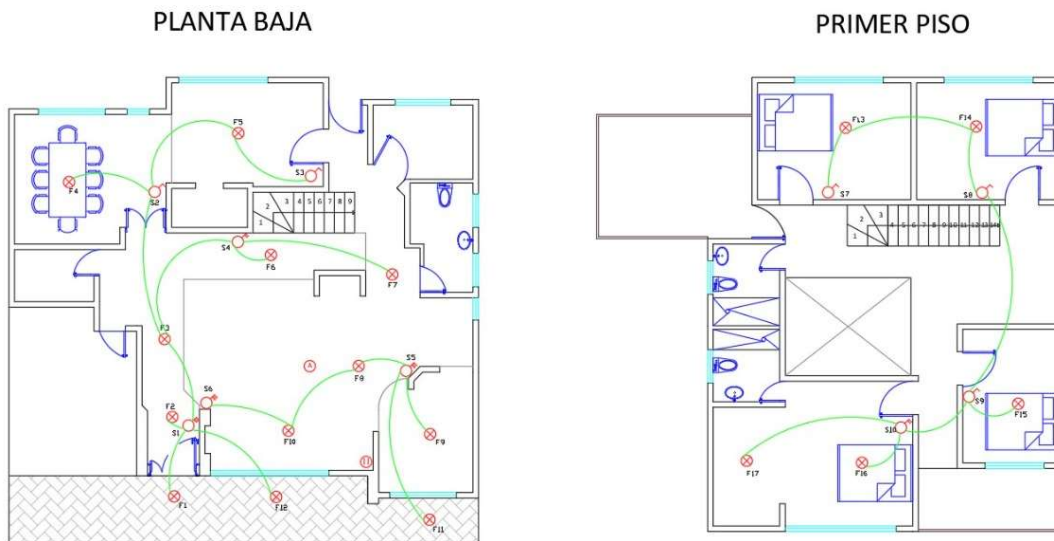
Planos de la vivienda con sistema domótico de bajo costo.
